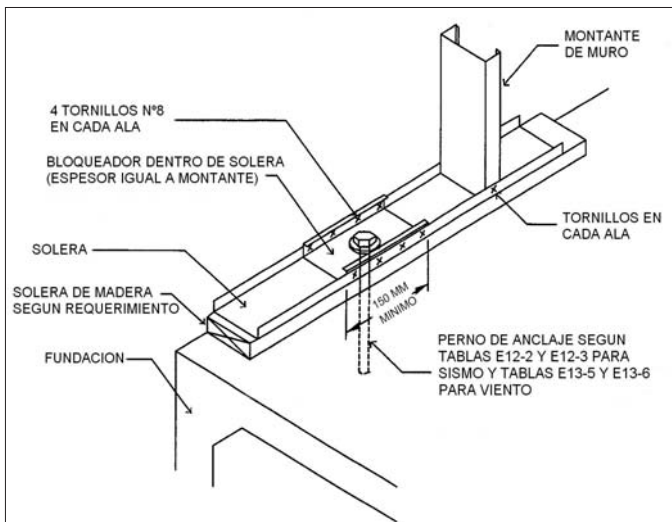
Conexión de Muro Arriostrado a Fundación con solera de Madera
